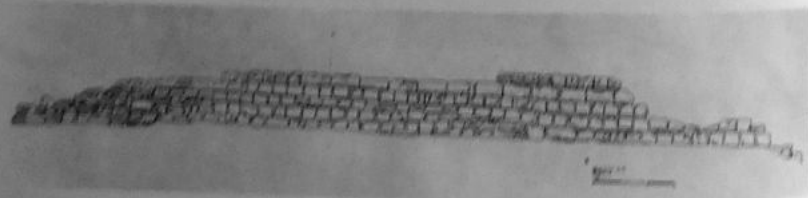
Prospetto del muro difensivo, lato Ovest.
